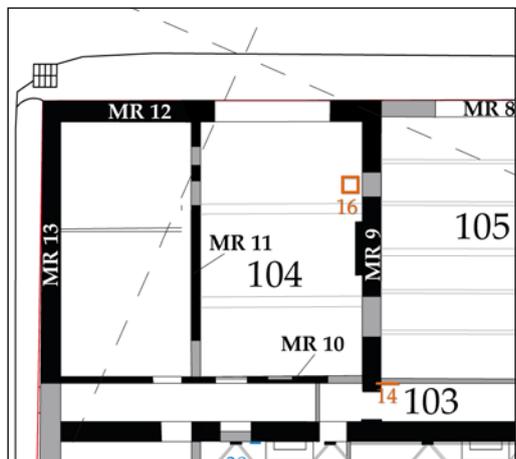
Plan de localisation des faits de l'espace 104 (DAO M. Panneau, S. Ranchin)
